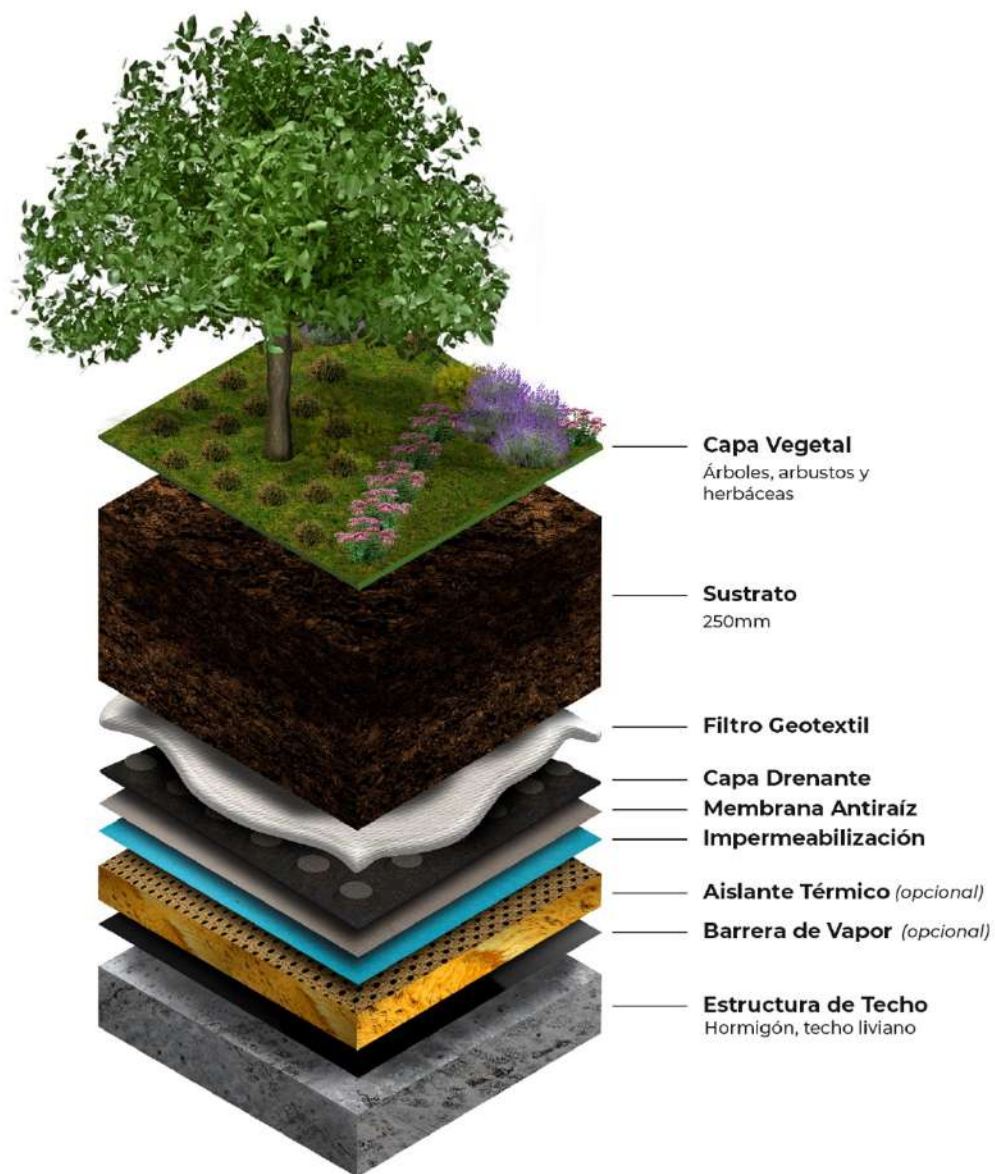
Sección típica de un techo vegetativo intensivo (Adaptado de Newton et al. (2007)).
